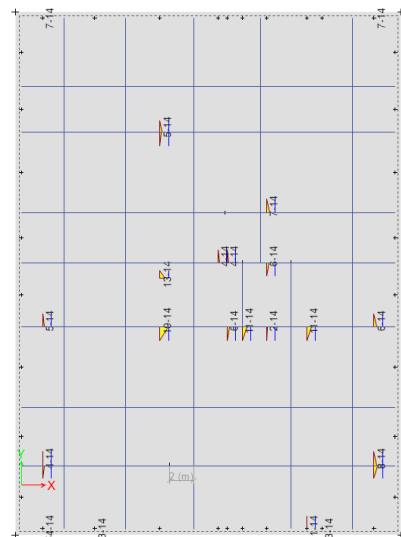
Ferrailage du radier sens y - face BOT RPA2024.
